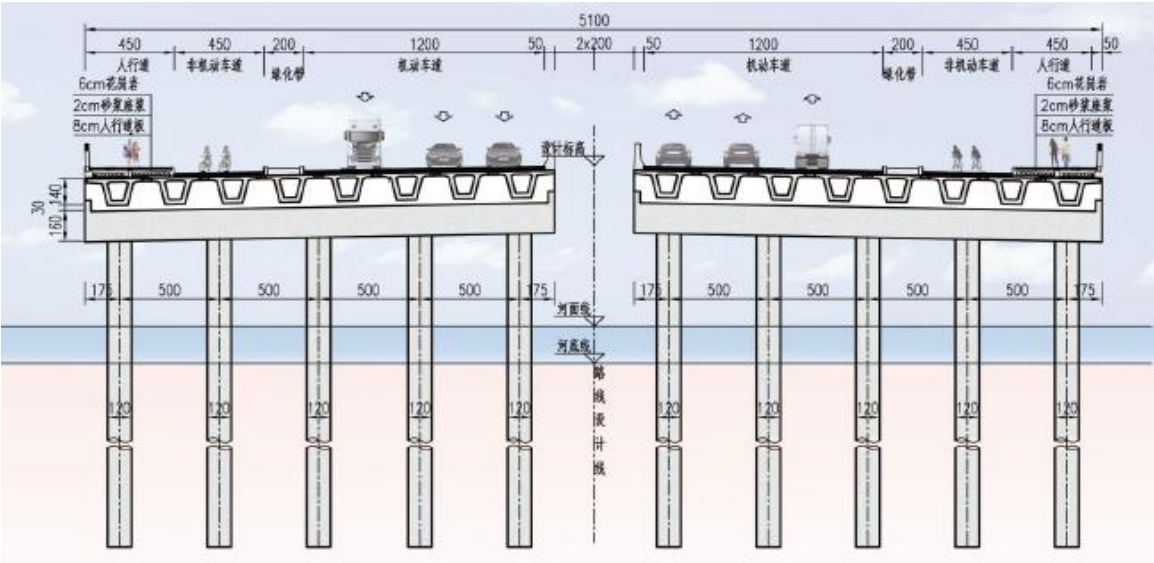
地面辅道新马沟 1 号桥横断面(单位: cm)
